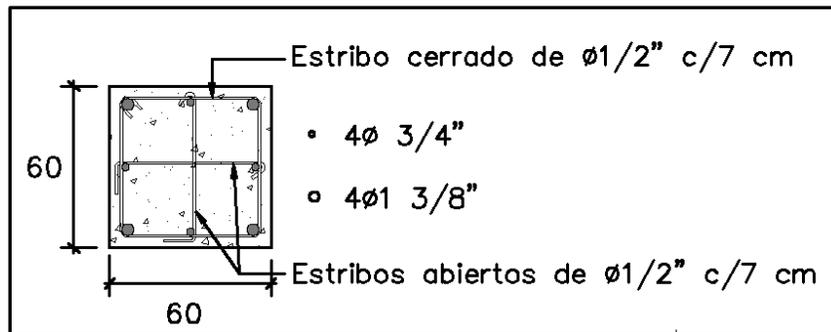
Detallado para CM1 aplicando los requisitos de confinamiento de en ND3 FONDONORMA 1753-2006. Fuente: Autor.
